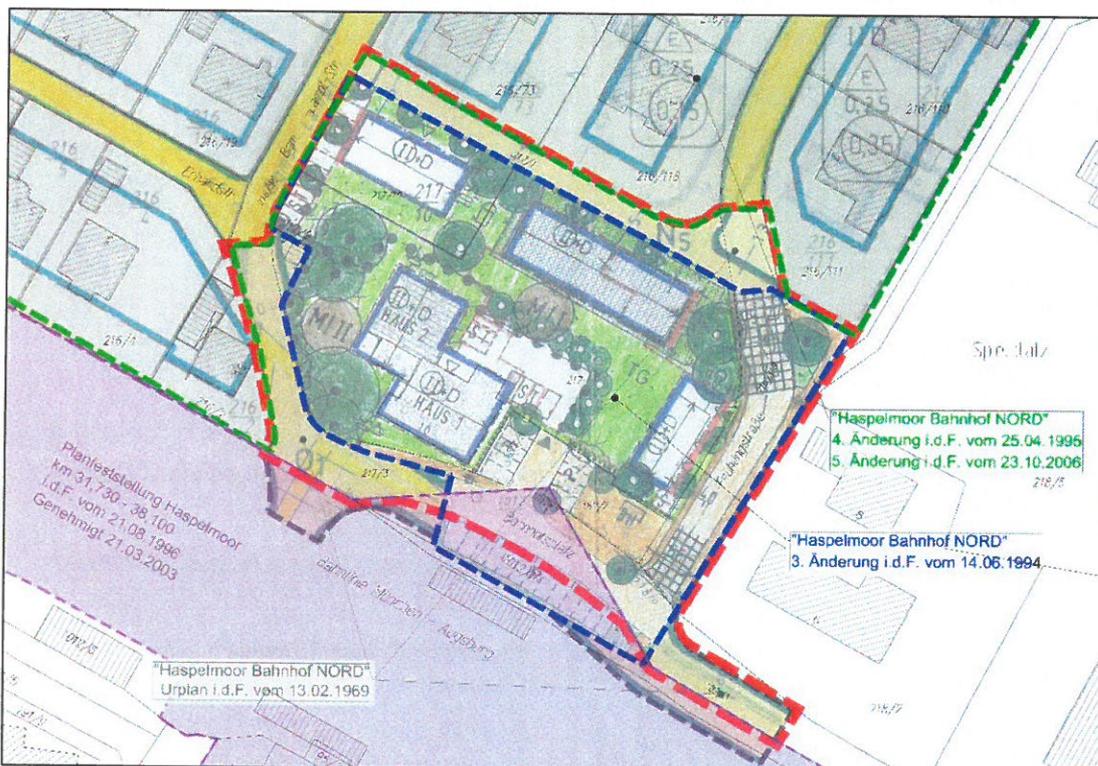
Rechtsverbindliche Bebauungspläne (rot: Änderungsbereich, grau: Urplan, blau: 3. Änderung, grün: 4. und 5. Änderung, violett: Planfeststellung)
